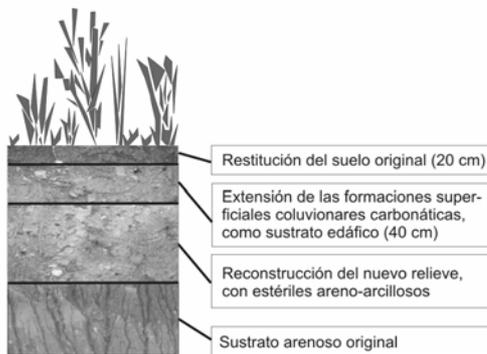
Propuesta de arquitectura del sustrato para la restauración de la mina El Machorro.
